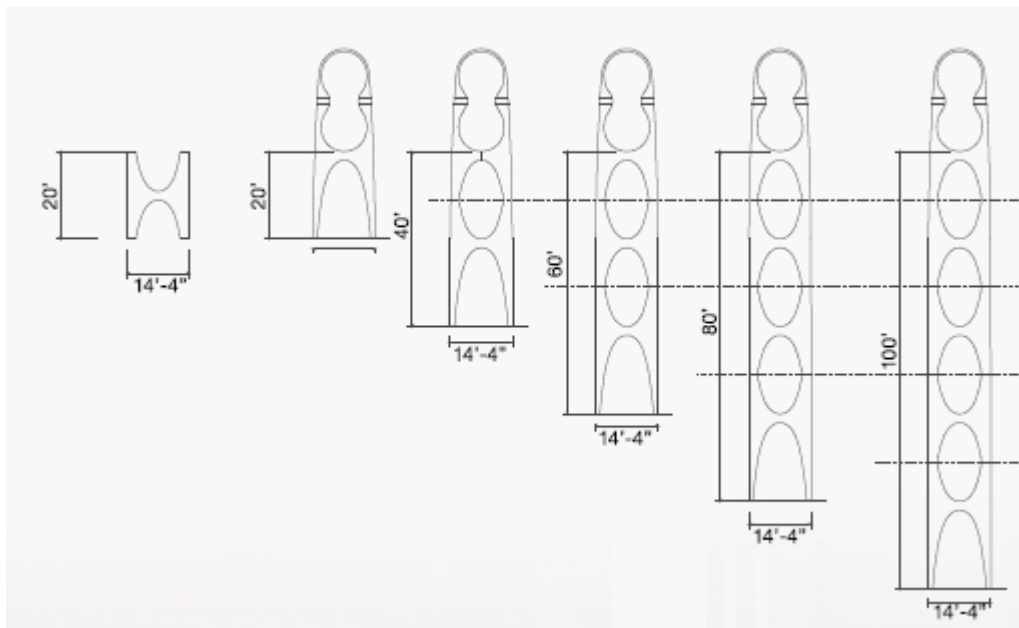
Estructuras de hormigón en el sistema Hyperloop
